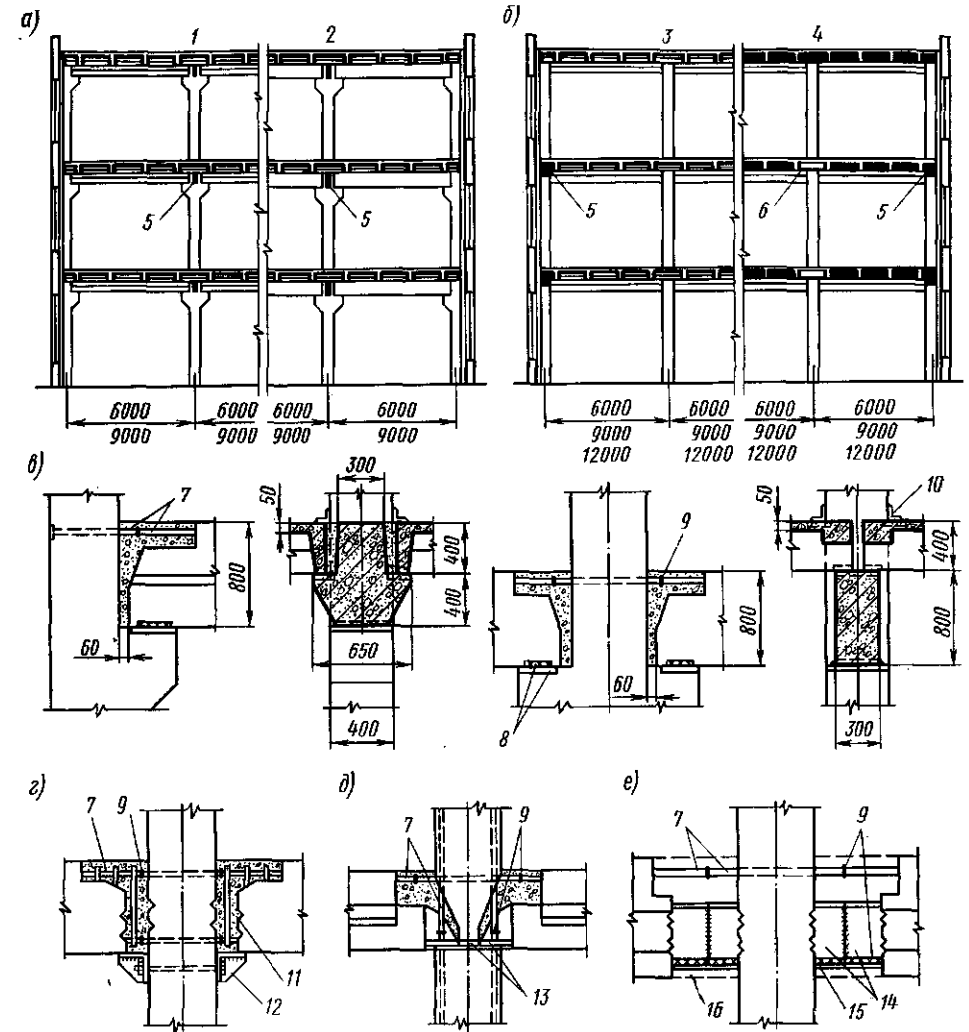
Многоэтажные здания со сборным балочным каркасом:
